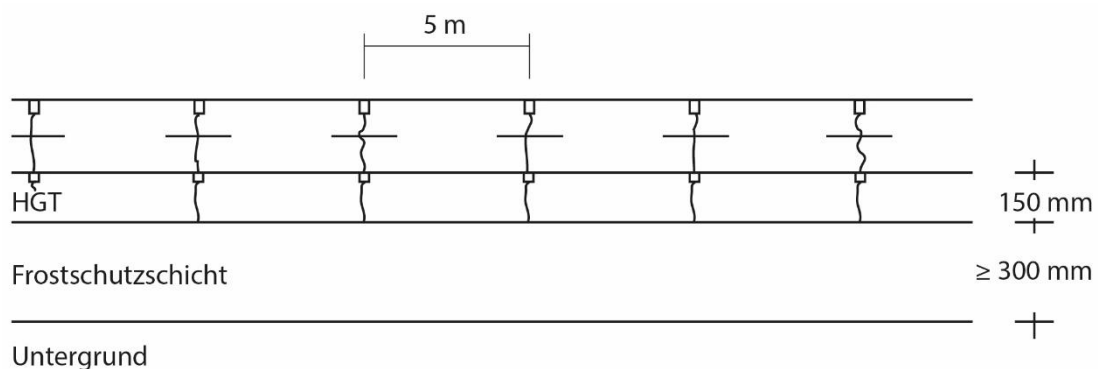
Längsschnitt einer Bauweise mit Querscheinfugen auf HGT im Verbund zur Betonfahrbahn
